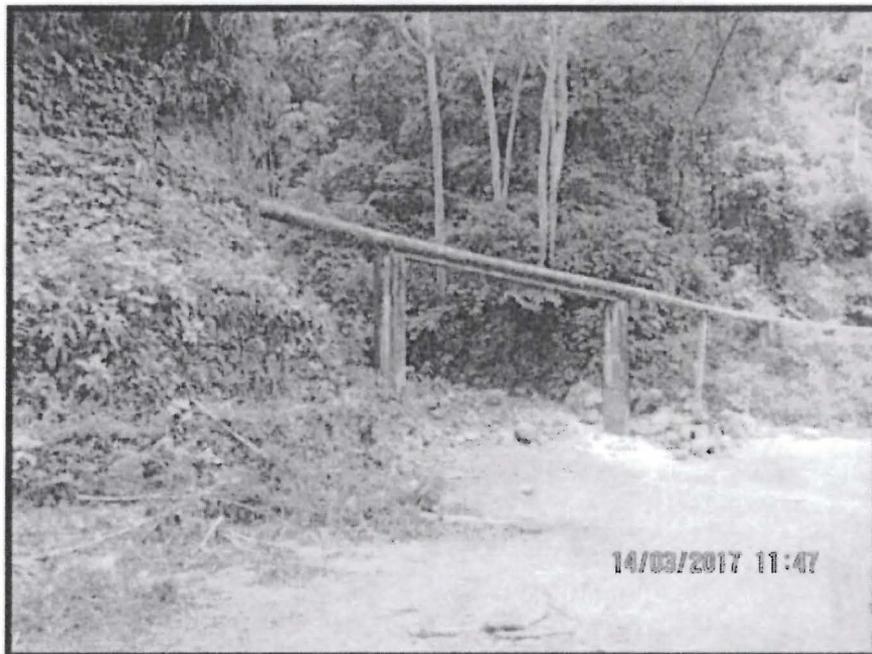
Vista de la parte superior donde ocurrió el deslizamiento, donde no se aprecia estructuras u obras de estabilización de taludes.
